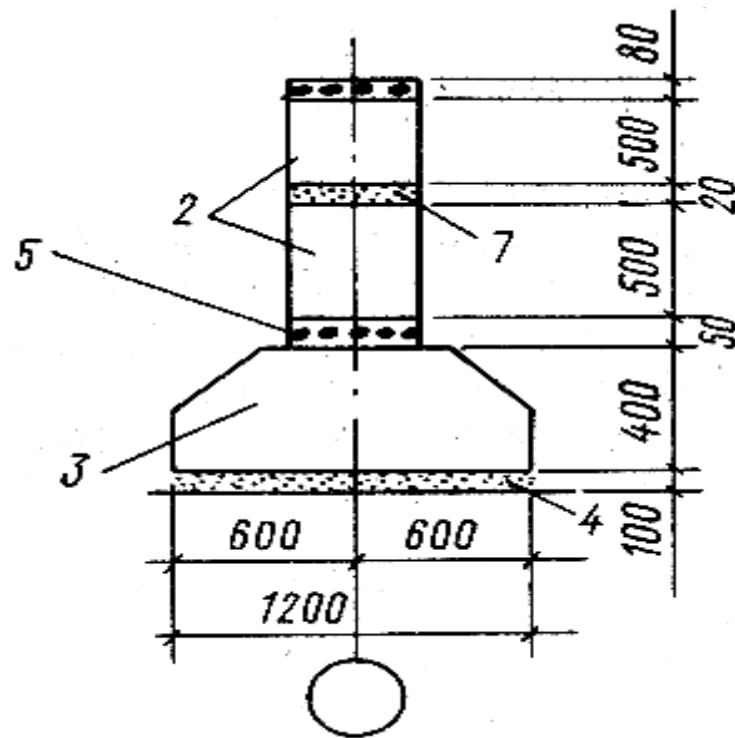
Схема збірного стрічкового фундаменту під стіни будівлі:
